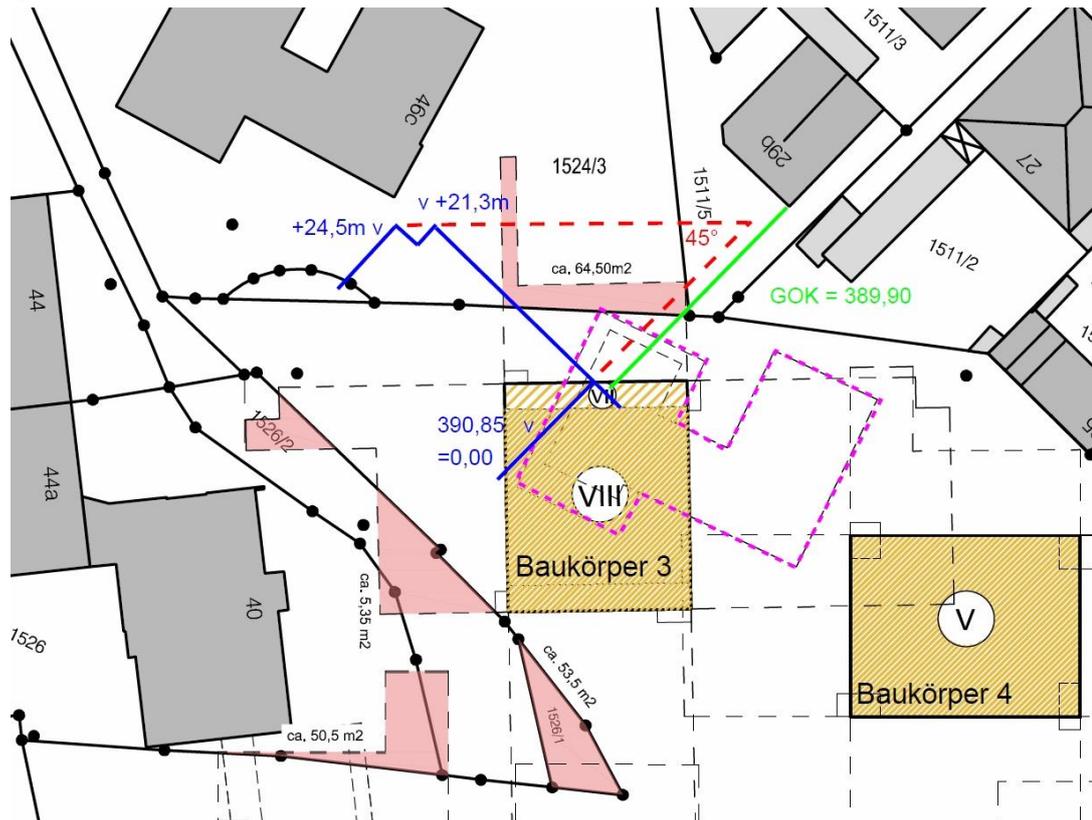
(Ausschnitt aus Abbildung 6) Auswertung Lichteinfallwinkel aktuelle Planung Gebäude 3 zum Anwesen Seligenthalerstraße 29b und Vergleich mit Baukörper des rechtsgültigen Bebauungsplans (magenta), unmaßstäblich
